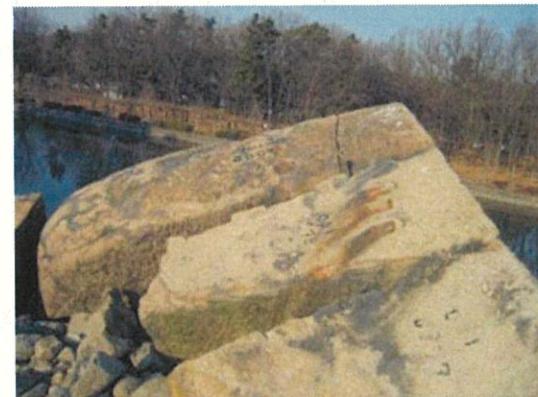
通常の石材配置状況（名古屋城本丸搦手馬出）
